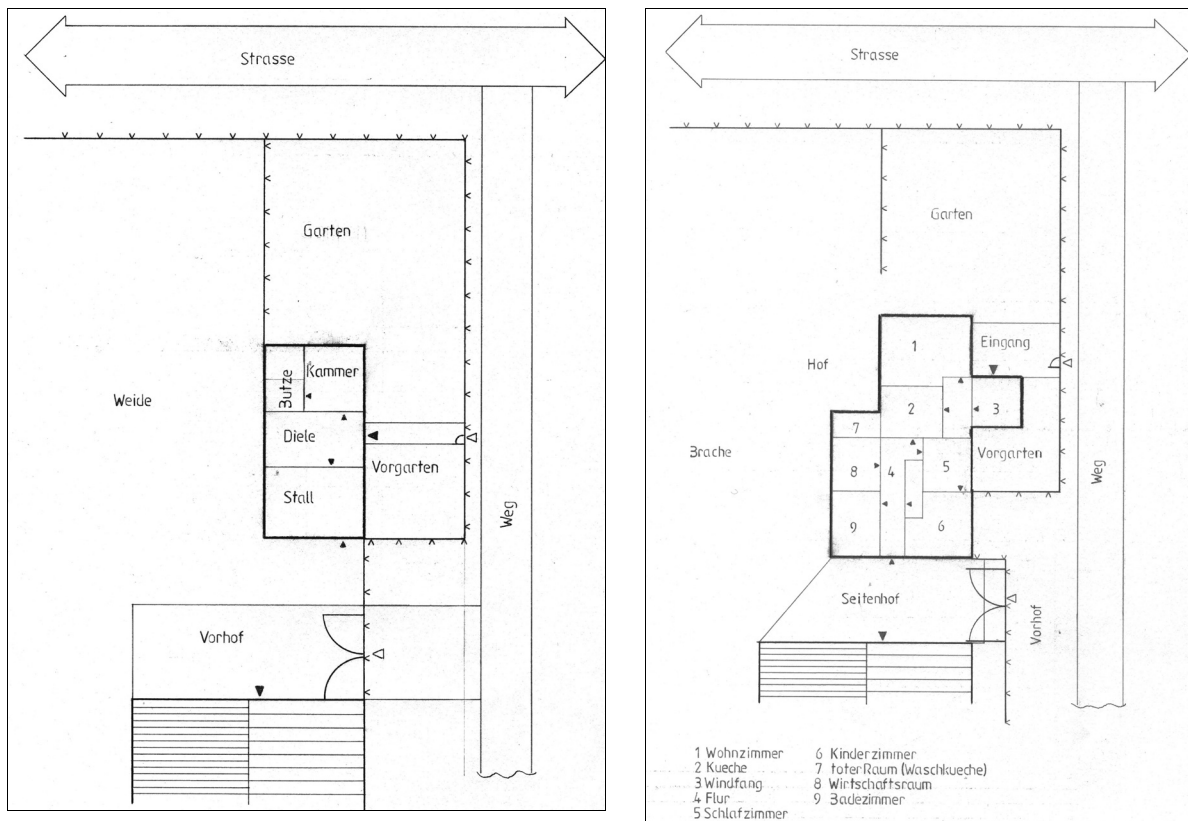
/37 Fachwerkhaus (alter und neuer Grundriss)
